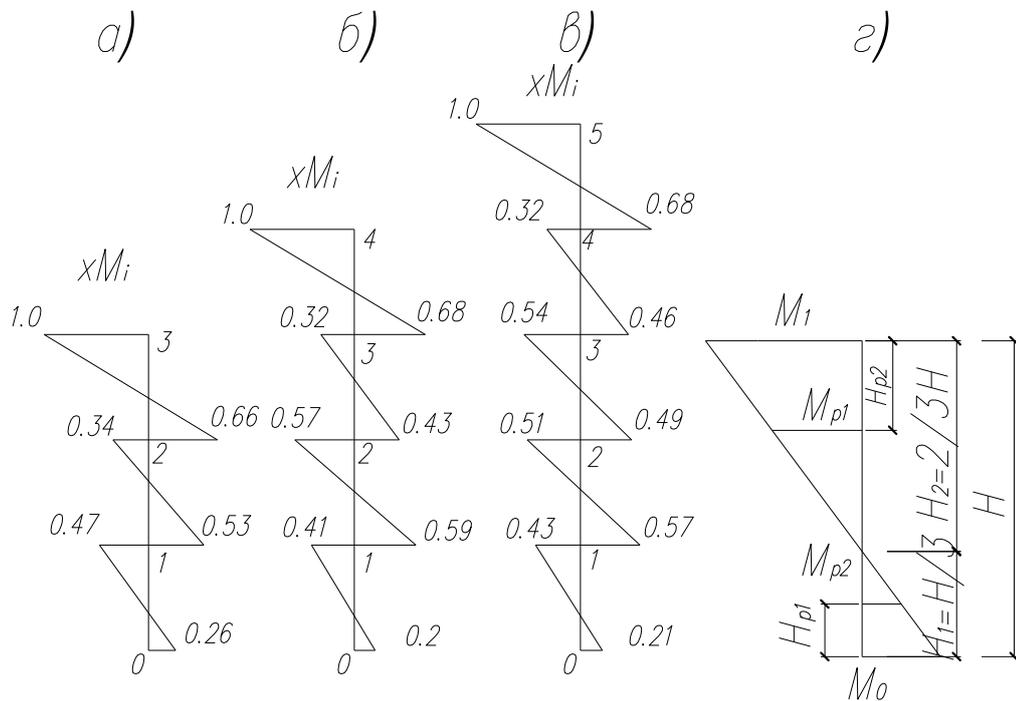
Эпюры изгибающих моментов в простенках здания разной этажности (в долях от M_i): а) трехэтажного здания; б) четырехэтажного здания; в) пятиэтажного здания; г) величины моментов в сечениях первого этажа
